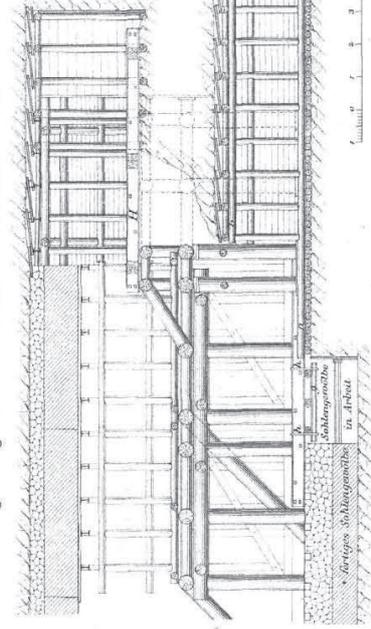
Auszimierung und Ausrüstung während der Ausführung des Mauerwerks mit Sohlengewölbe.
